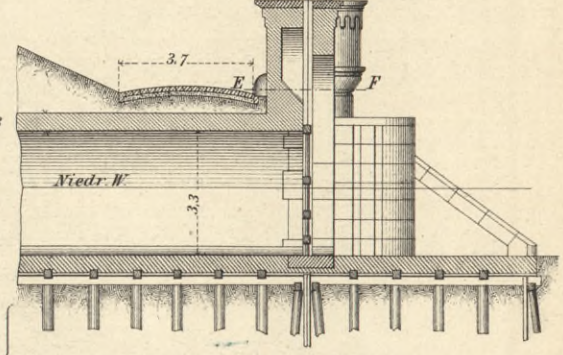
Teil des Grundrisses. (Schnitt EF.)
